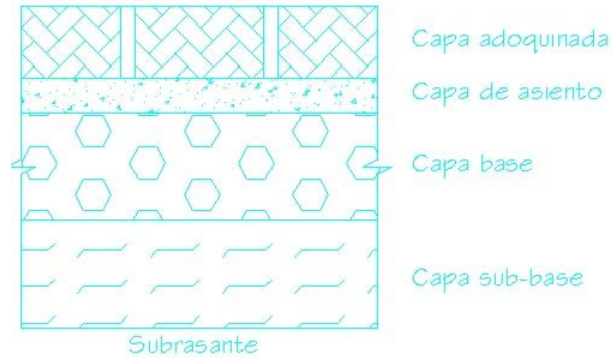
Detalle de pavimento de adocreto. Fuente: (Moncayo V., s.f.)
